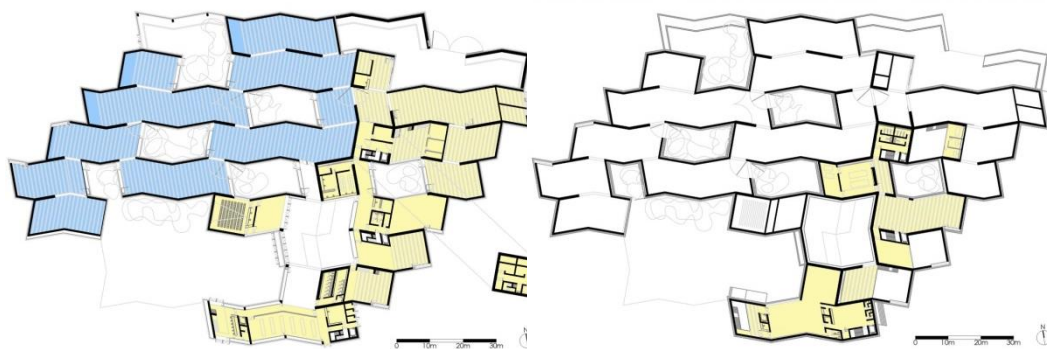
MUSAC, planta piso 0 e planta parcial
